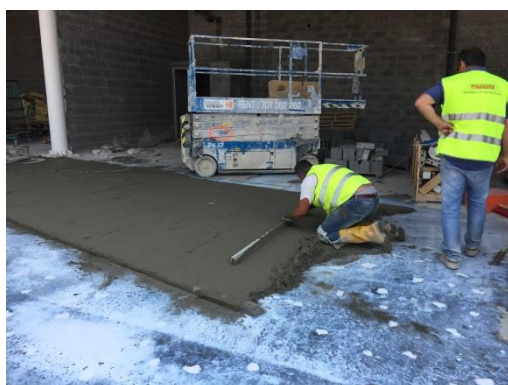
Enchimento do pavimento com betonilha [Data: 25.07.2017]
